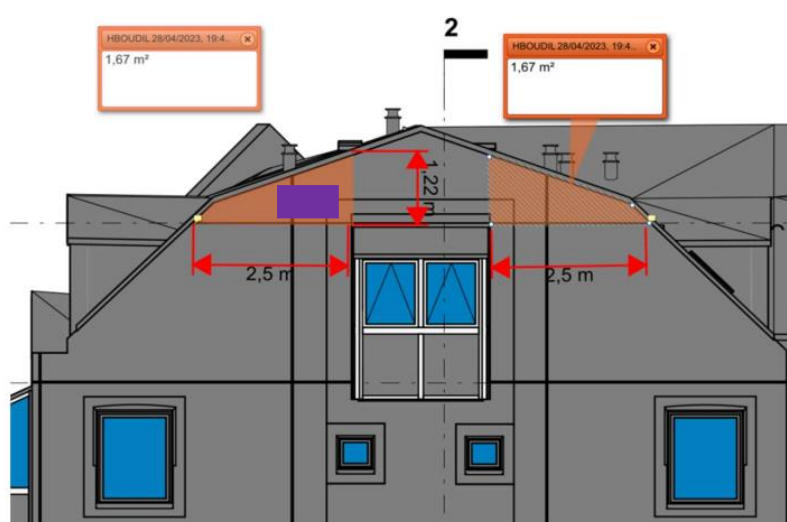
Exemple d'emplacement de gîte inclus sur un pignon d'un bâtiment du site
